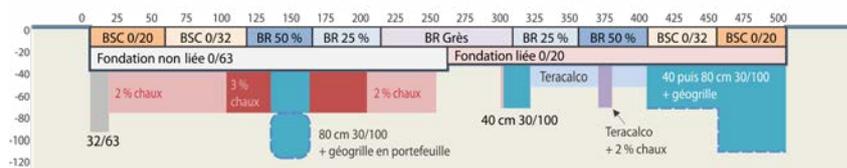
Profil en long de la section d'essais après préparation du sol-support
